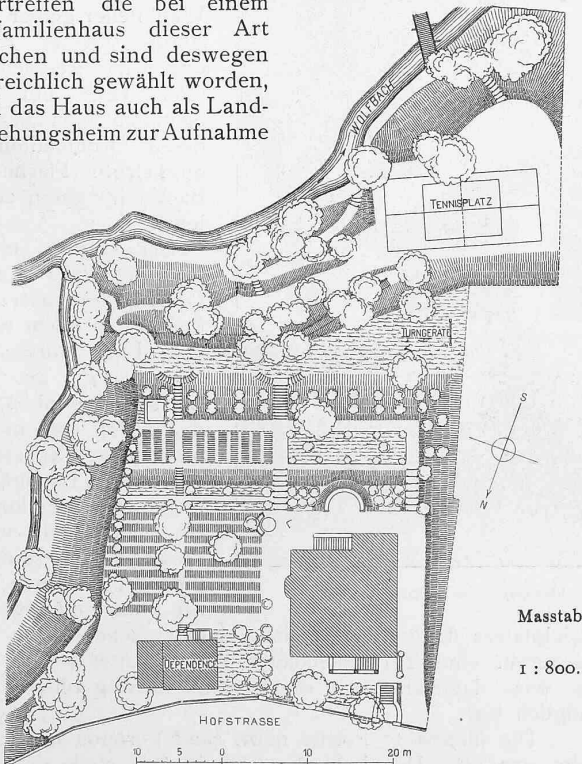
Lageplan der Villa «im Oberland» in Zürich V.
